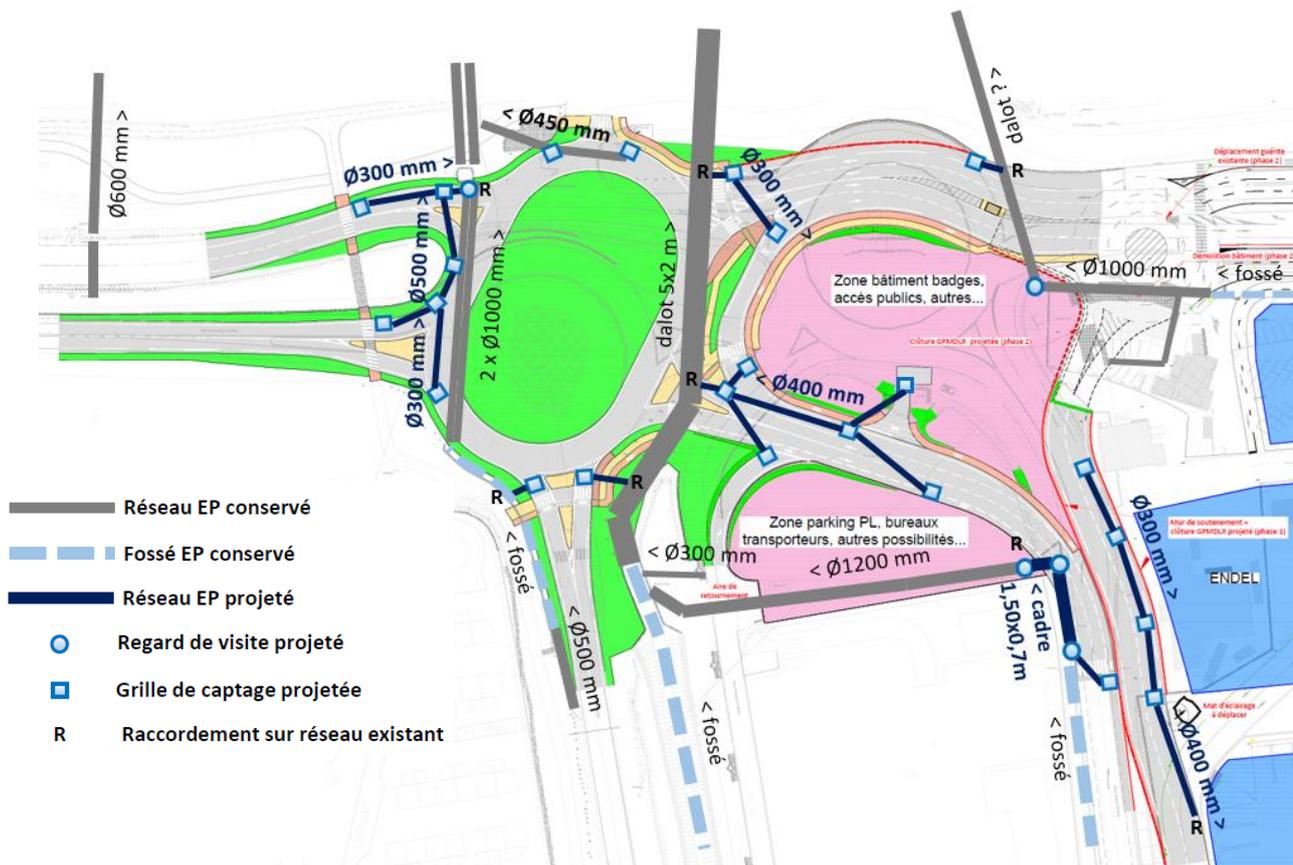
Plan des réseaux d'eaux pluviales projetés
